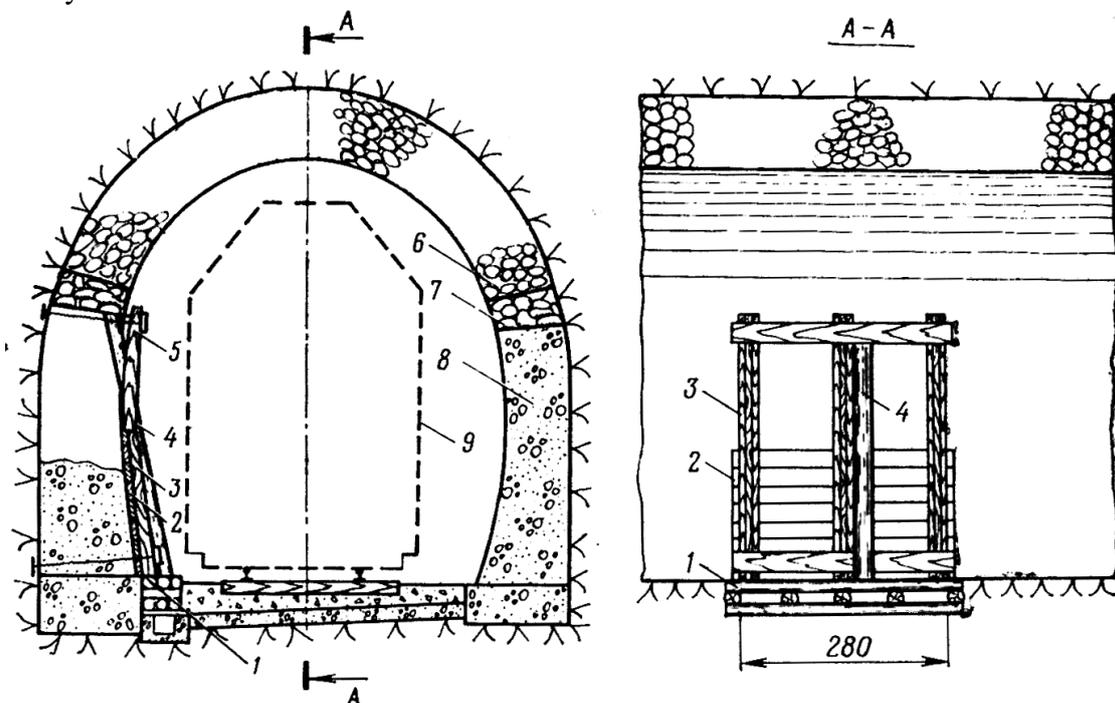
Перекладка стен тоннеля, расположенного в скальных породах:
